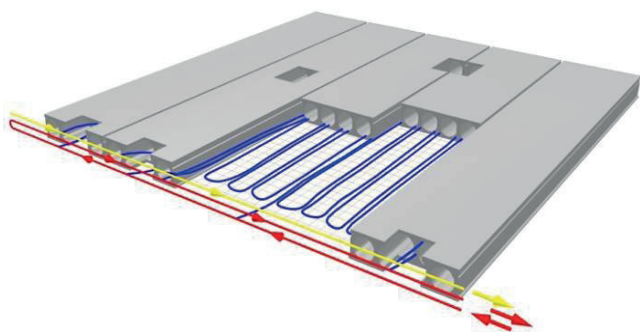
Metoda BIM zastosowana w prefabrykacji
